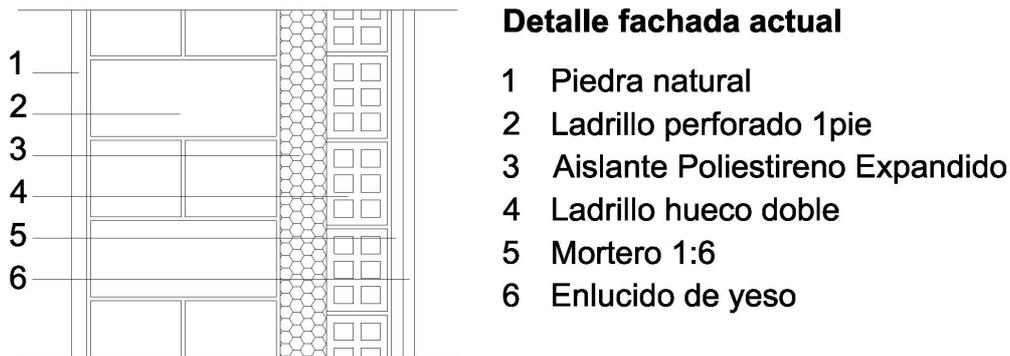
Detalle fachada actual. Fuente: Elaboración propia
